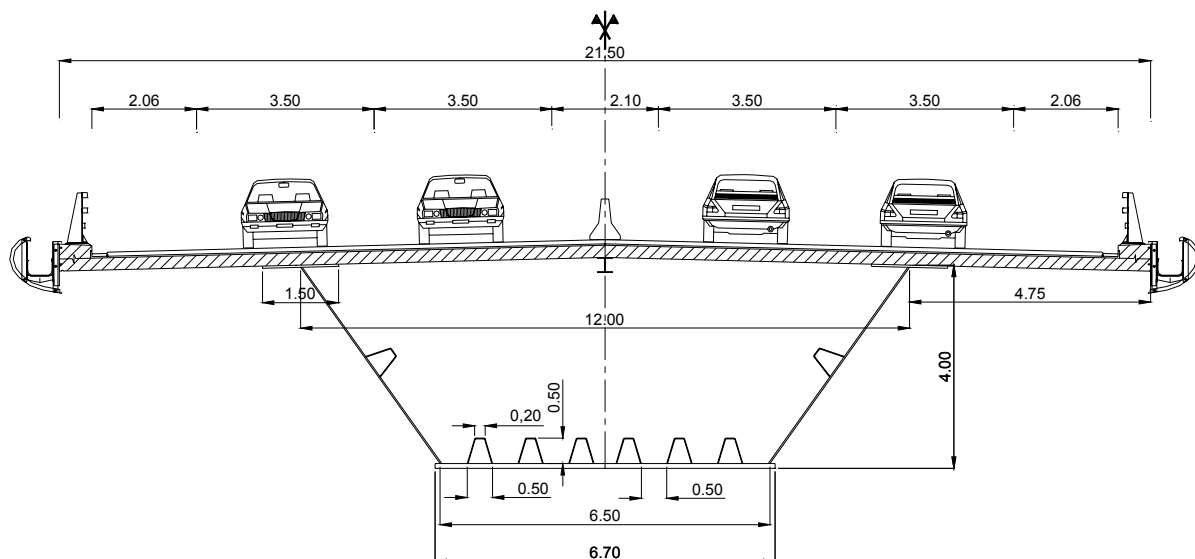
Querschnitt der Hohlkastenbrücke.
